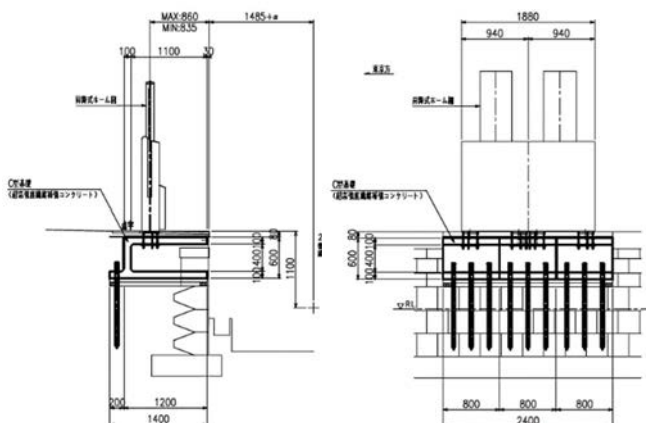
ホーム柵構造断面図 図-2 ホーム柵構造正面図
